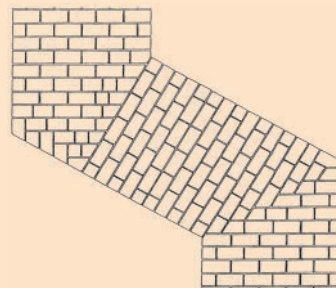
Esquina en ángulo obtuso. Encaje alternante.
